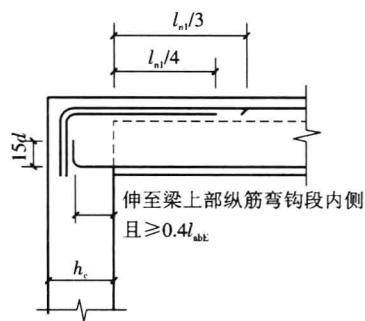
屋面框架梁纵筋在端支座处的弯锚构造
